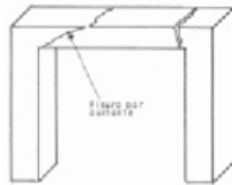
Helene, P. (2003). Manual de rehabilitación de estructuras de hormigón [Figura]. Recuperado de <https://es.scribd.com/doc/35762562/Manual-Rehabilitacion-de-Estructuras-Hormigon-Reparacion-Refuerzo>
